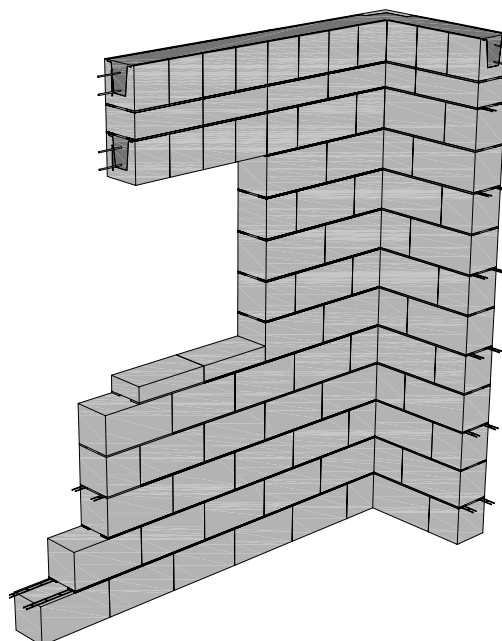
Pilaster av Leca Konstruksjonsblokk
